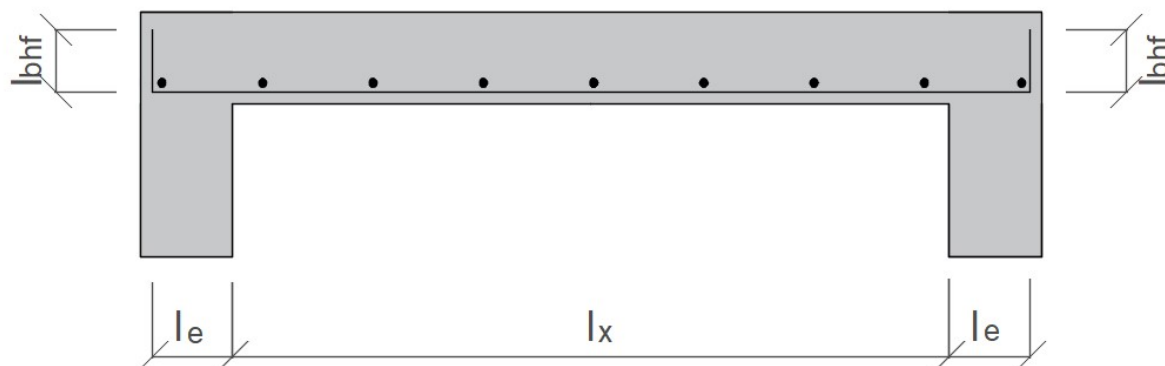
Comprimento das armaduras positivas das lajes BFRP
